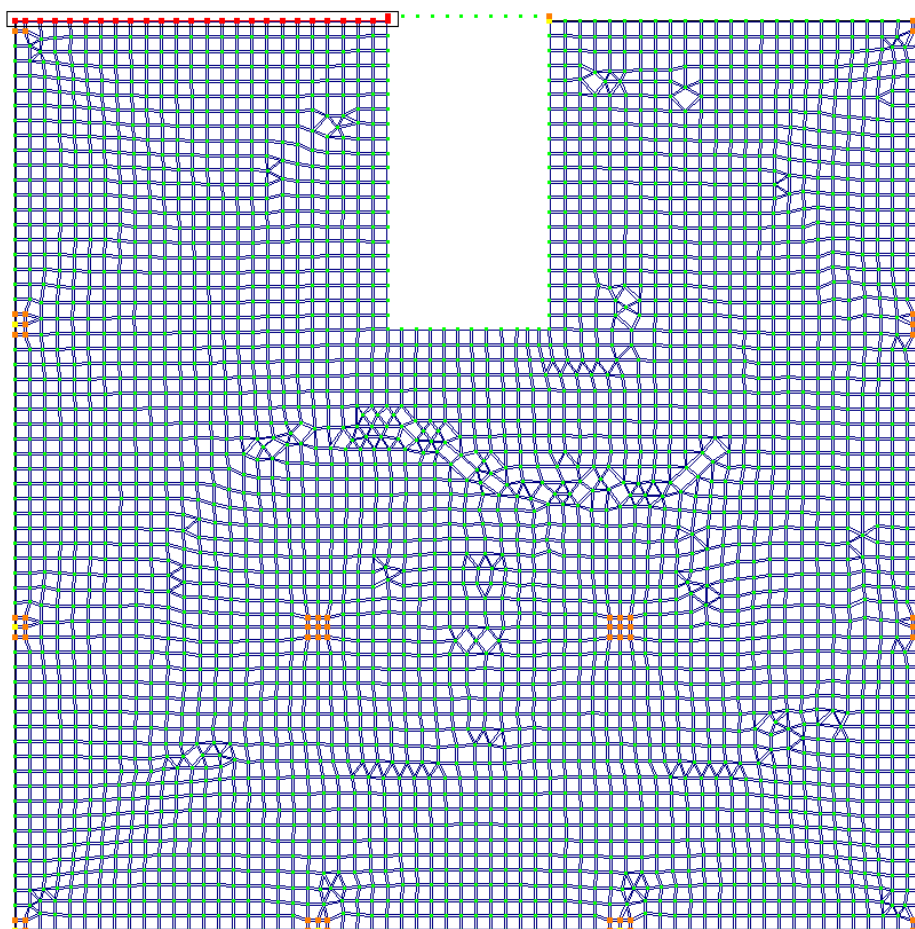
Схема перекрытия первого этажа с выделенной контурной балкой
